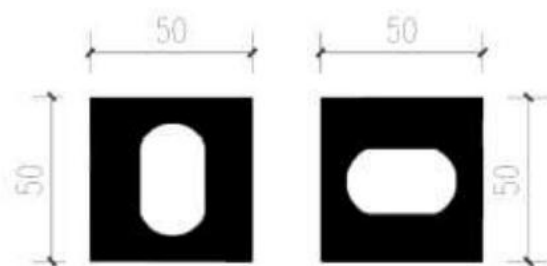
竖向、横向连接板示意图(单位: mm)
